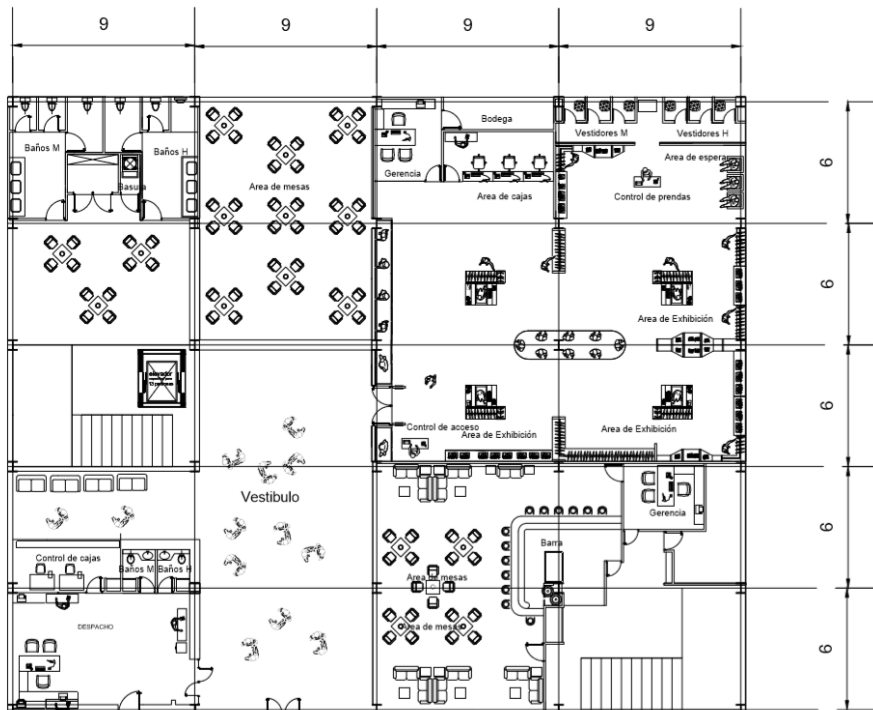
Distribución planta baja. Obtenido en Plano de distribución en planta, planta baja.
